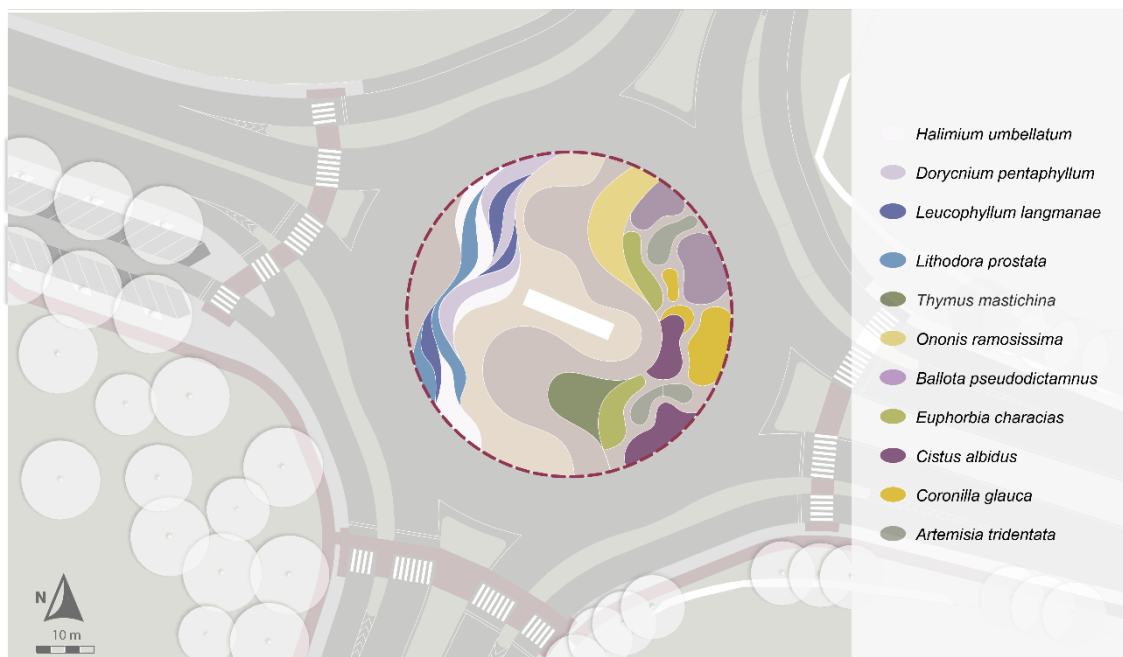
Plano de plantação da rotunda do Alegro, Setúbal, sem escala real.
